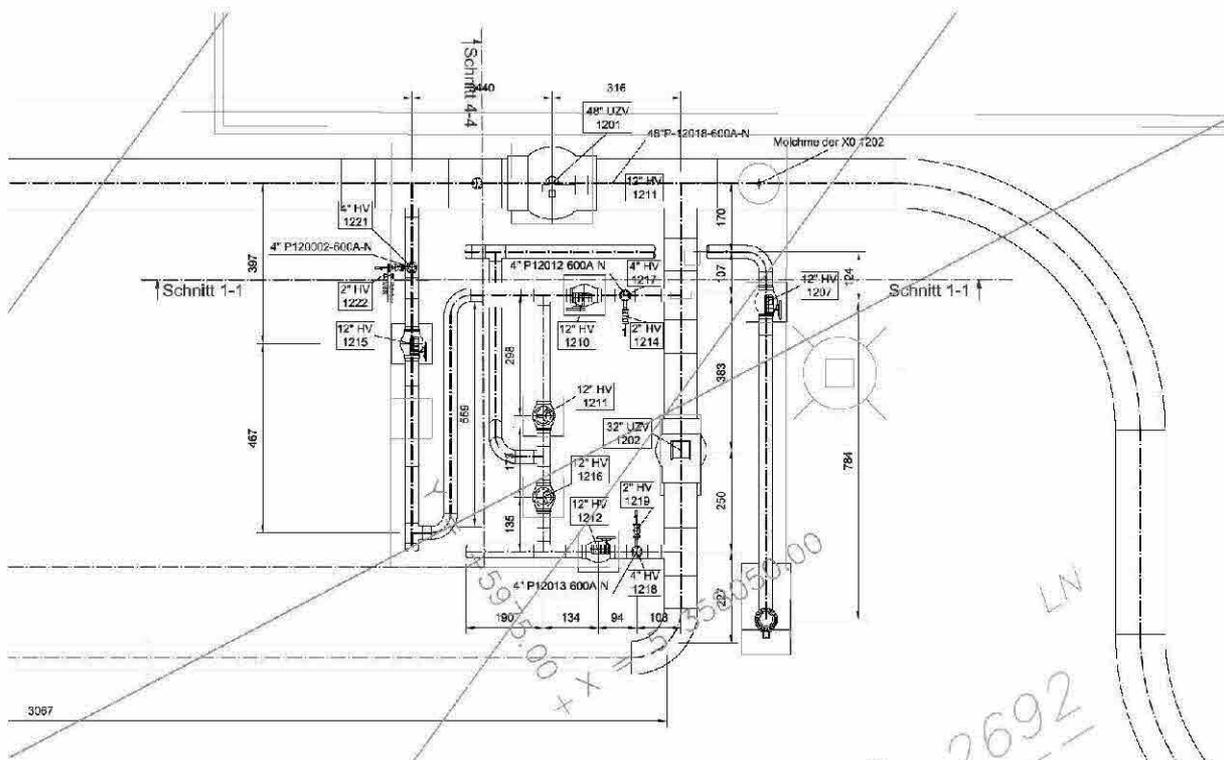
Ausschnitt Rohrplan Schieberstation⁶⁴
